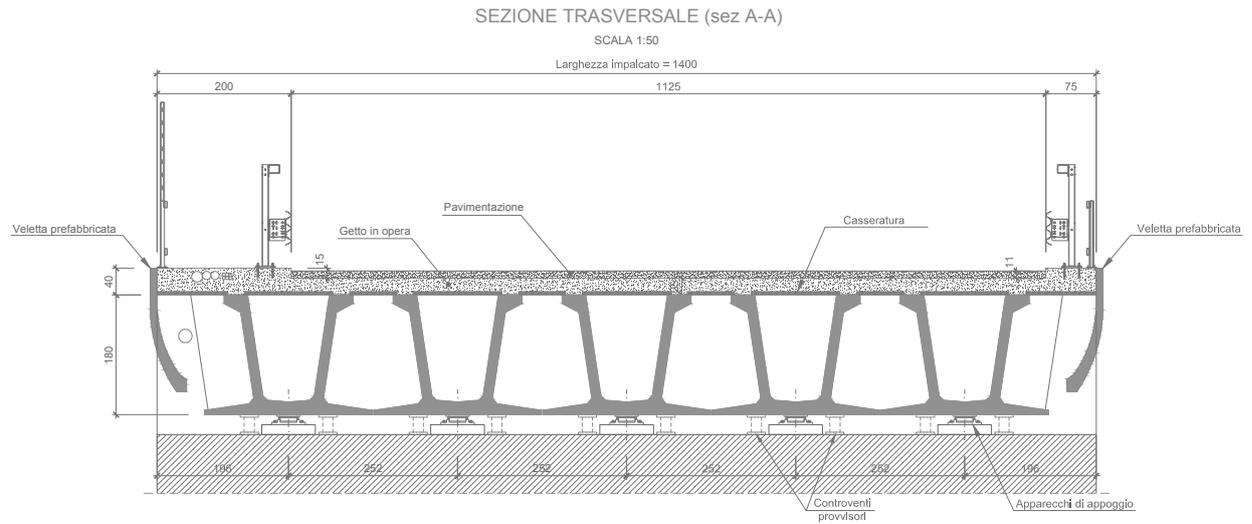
Sezione trasversale Ponte Torrente Chiavon asse Nord
